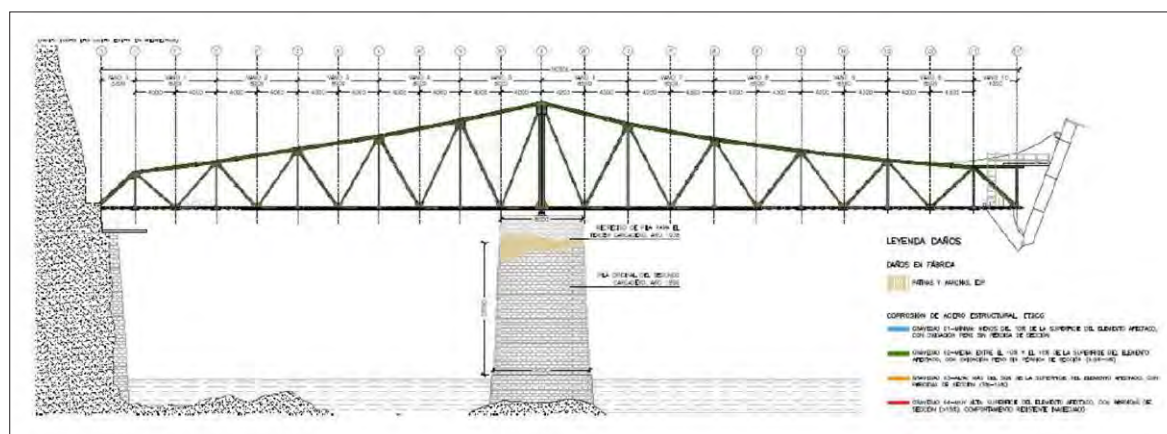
Vista de los daños sobre el alzado del cargadero de Dícido.
